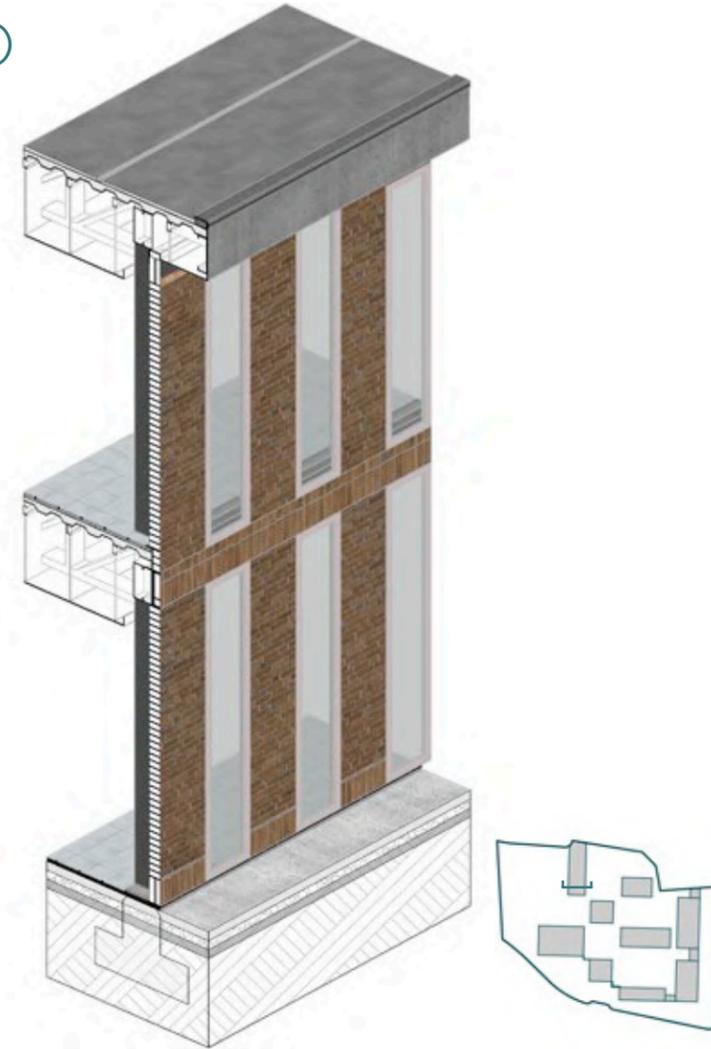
| Elevation, section and details aulario escuela/ mantenimiento | Fuente: Elaboración Propia
